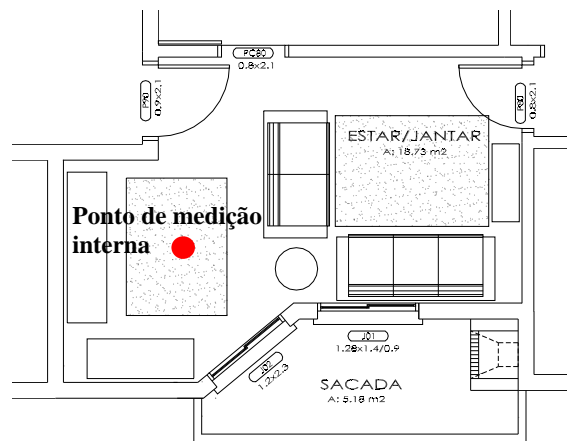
Planta Baixa da Sala e Sacada do Apartamento em estudo.
